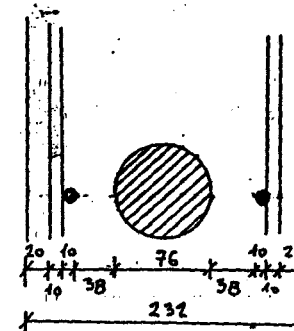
Disposition du câble et des aciers dans l'âme
